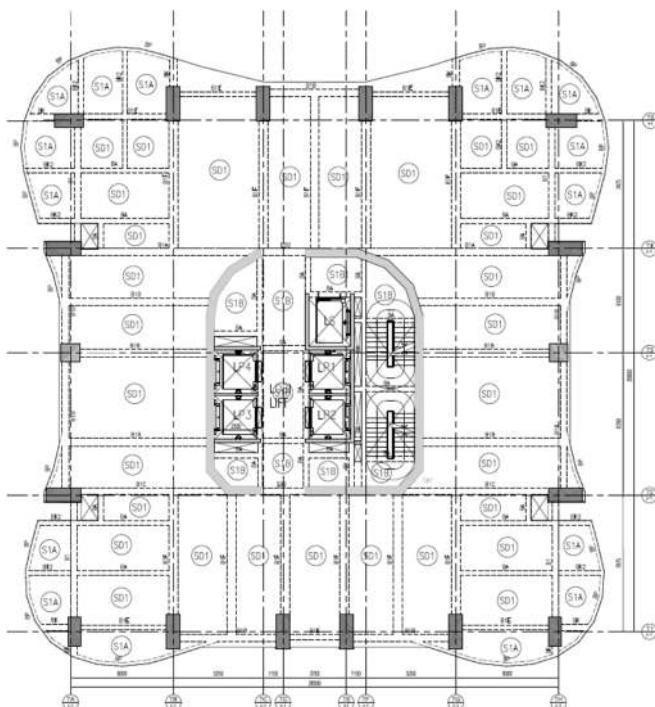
Denah balok precast U-Shell Lt. 4-11
